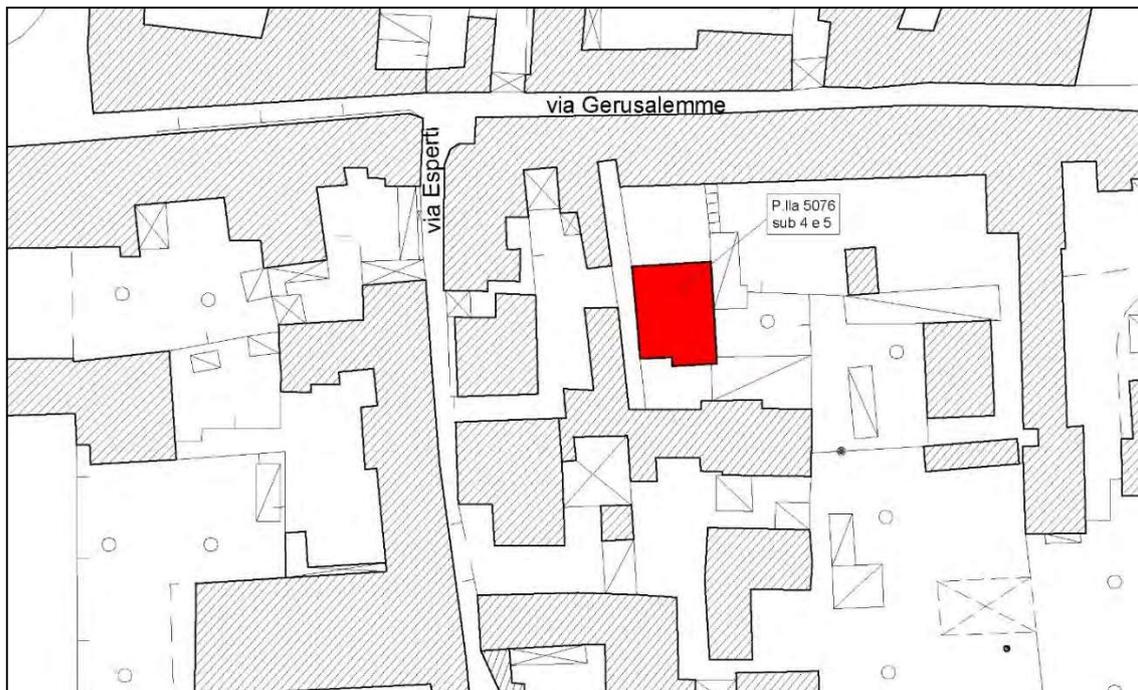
Planimetria generale dell'area del fabbricato (alleg. 2)
